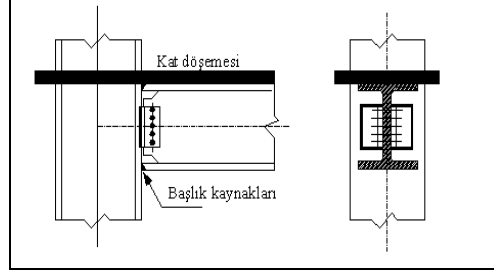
Dallanmış kolon-kiriş birleşim biçimi
